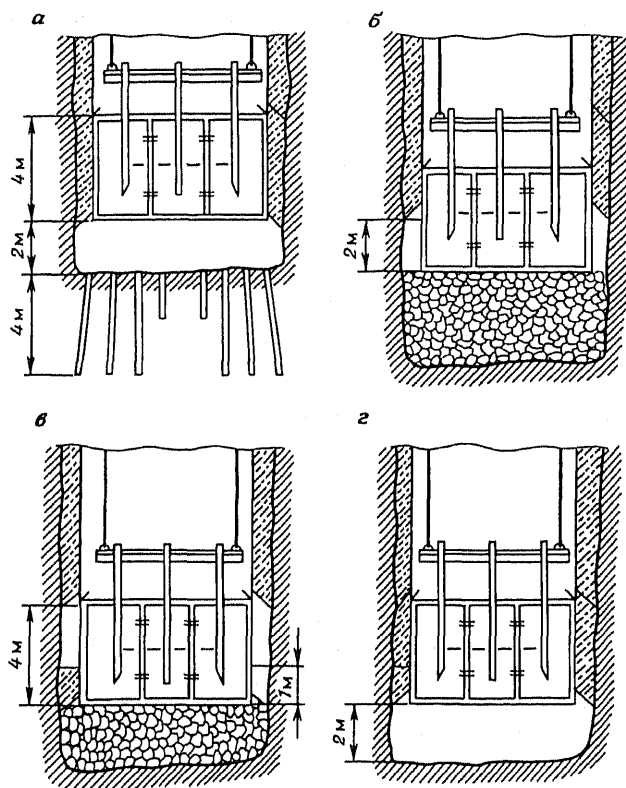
Схема возведения монолитной бетонной крепи при совмещенной схеме проходки стволов:
